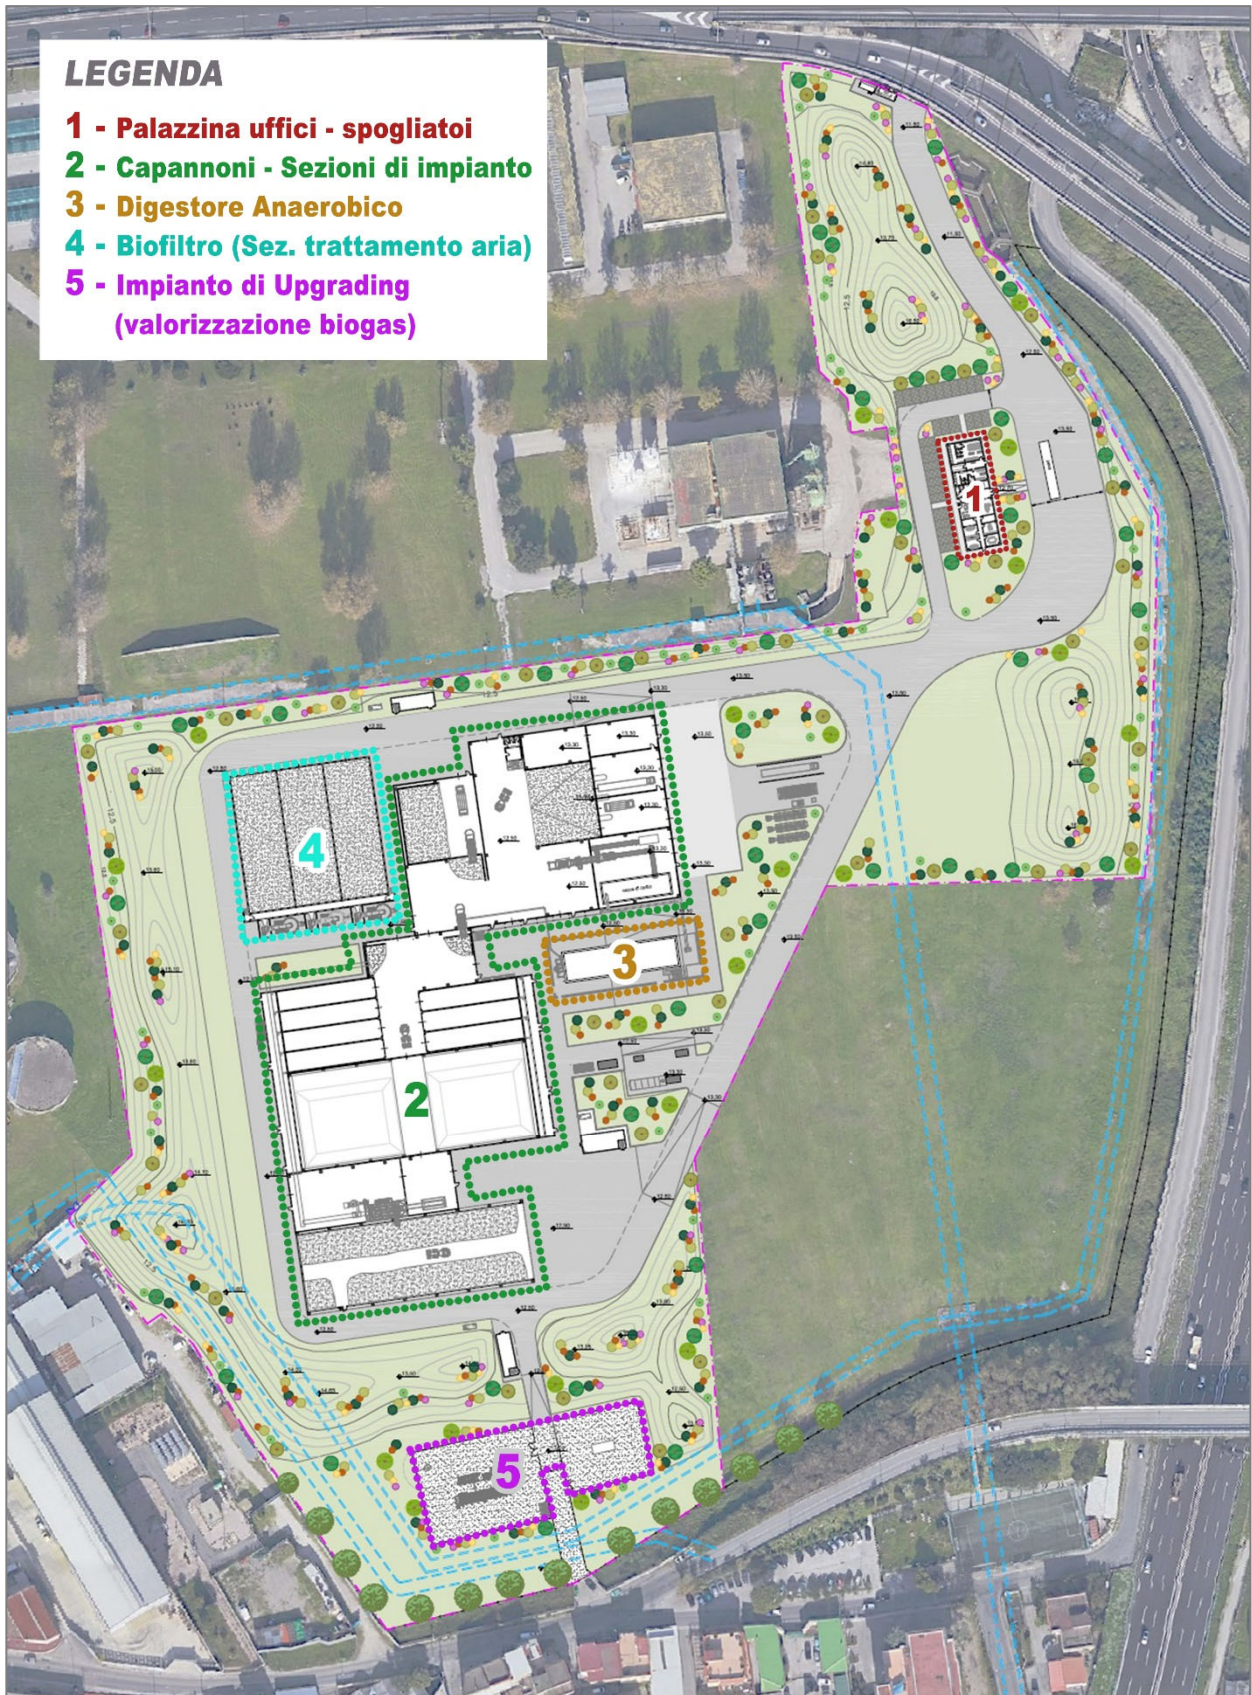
Planimetria generale: fabbricati e manufatti edilizi facenti parte del complesso impiantistico
